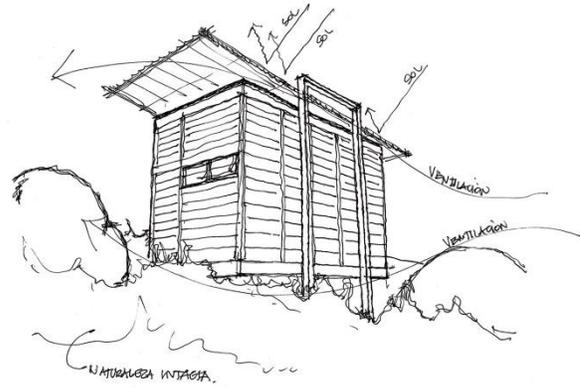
Conjunto y planta arquitectónica. Vía plataforma arquitectura.cl
